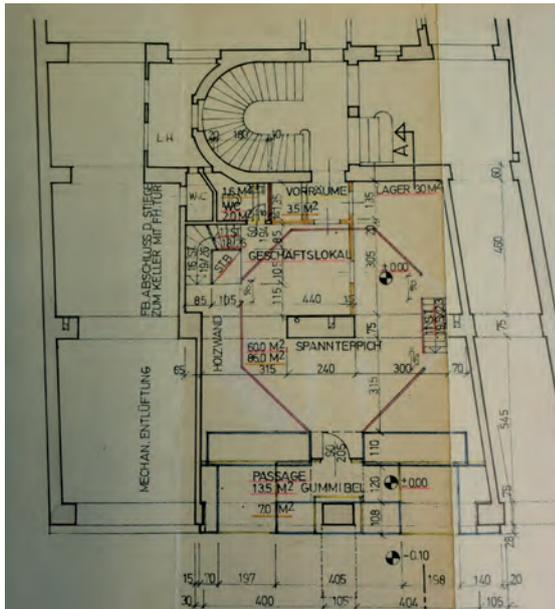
Grundriss Schuhhaus Wimmer
